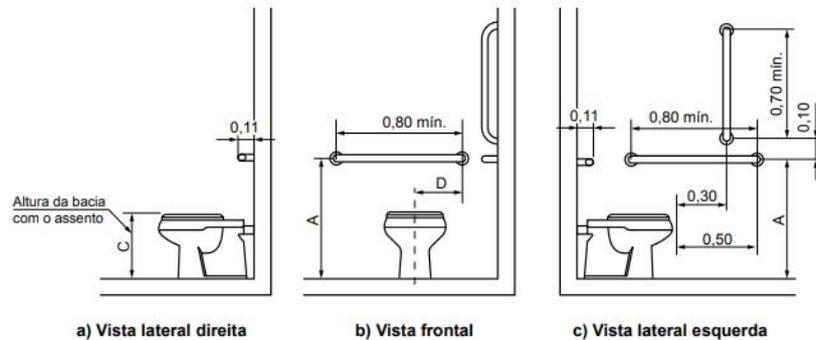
Ilustração de fixação da barra de apoio no banheiro
